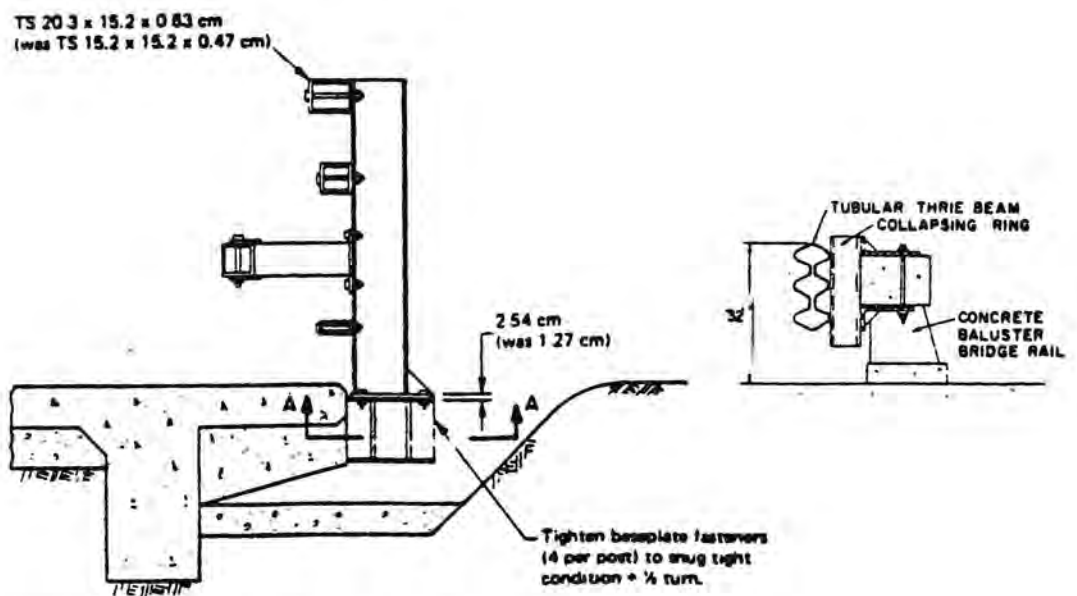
Constructie met kruimelbeton afstandhouder 2
